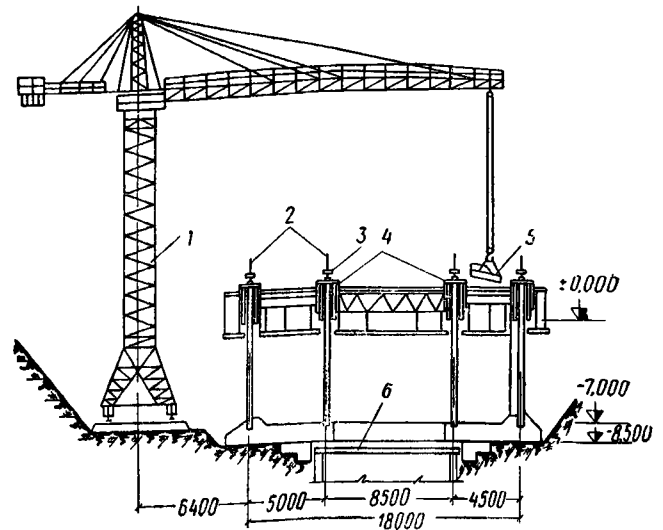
Бетонирование фундамента башенного копра в скользящей опалубке
